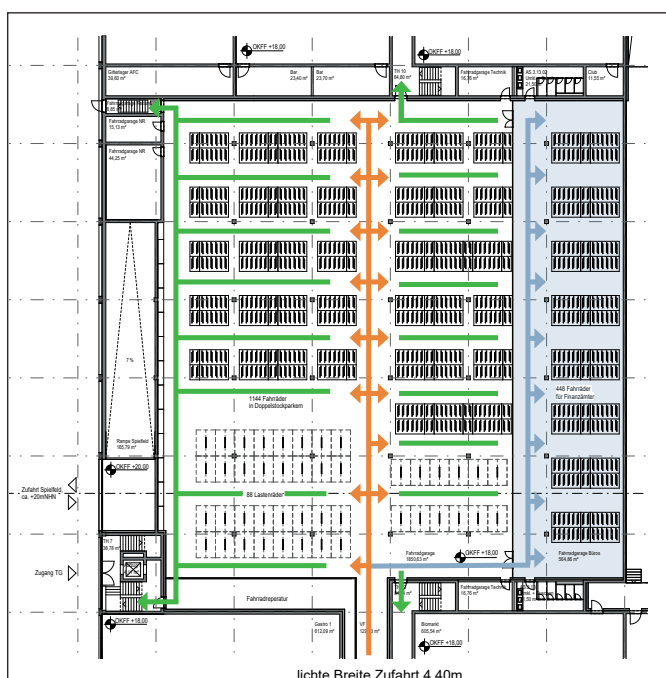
Grundriss Fahrradgarage mit Wegekonzept. Quelle: GMP
